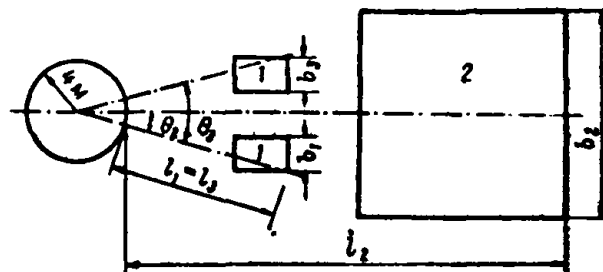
Схема к расчету пригрузок от поверхностных сооружений:
